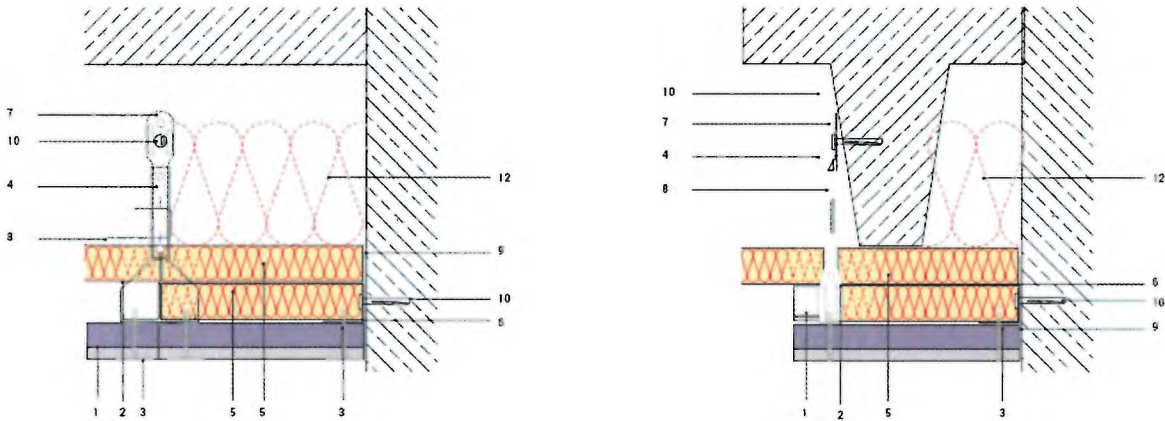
Ausführungsdetails Wand- und Deckenanschluss
